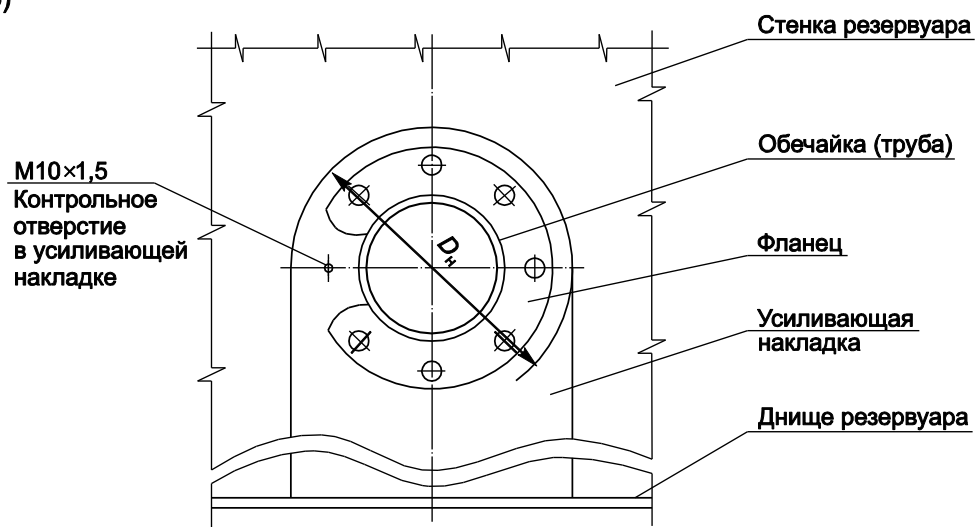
Общий вид патрубков в стенке резервуара:
